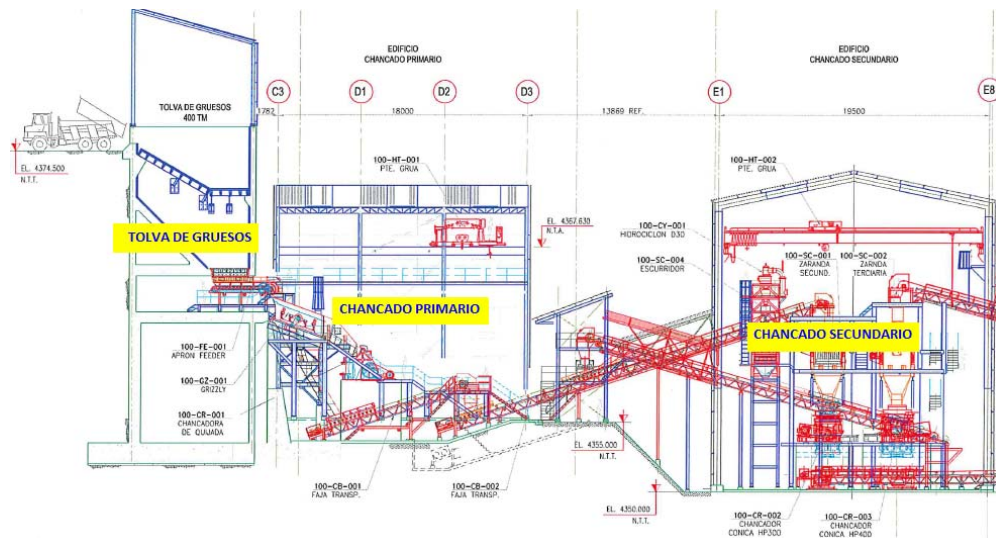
Edificio de Chancado Primario y Secundario (Fuente: Empresa consultora ABC)
